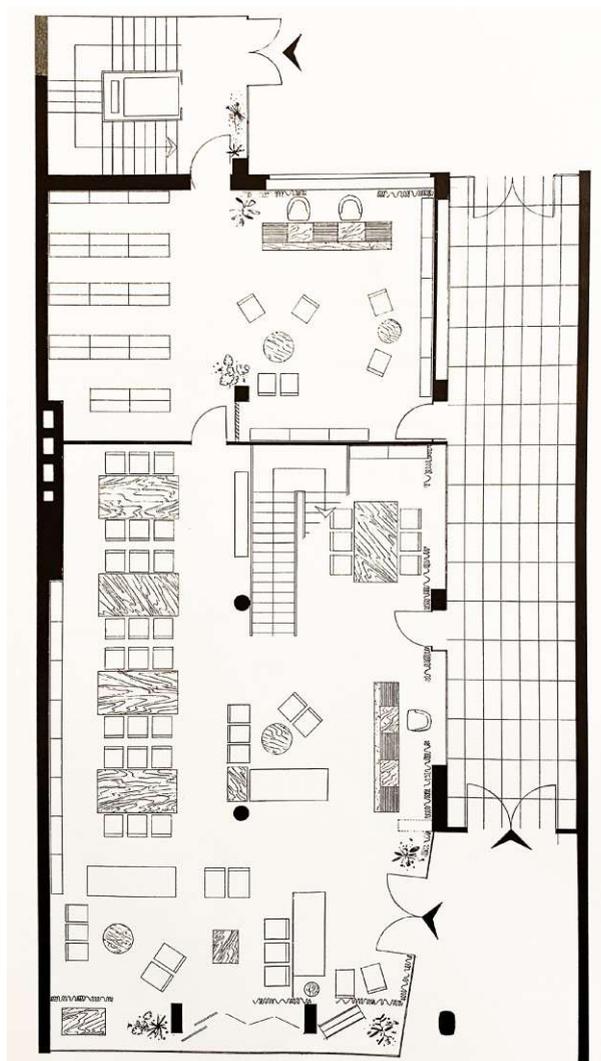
Artur Perotti, Amerikahaus Grundrissplan Erdgeschoß, 1952.
